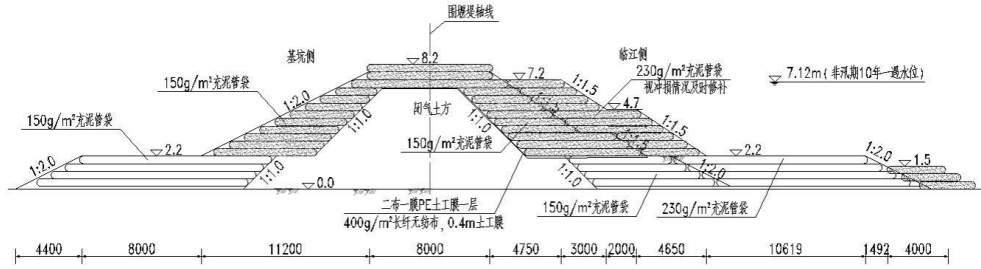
龙潭泵站外江侧围堰典型断面图（单位：mm）
